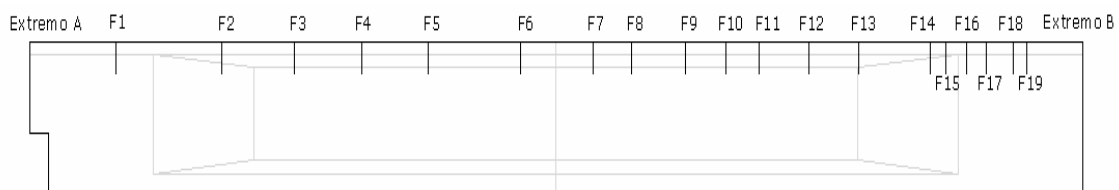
Esquema de localização das fissuras observadas na viga pré-fabricada sujeita a cura térmica
